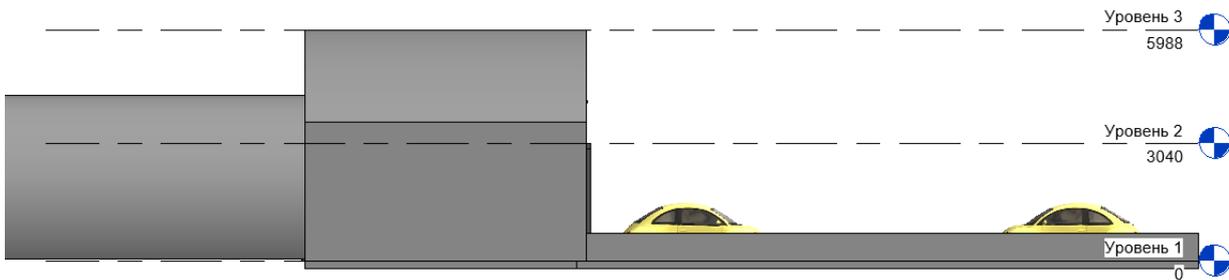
Архитектурно-планировочное решение (фасад - западный)
